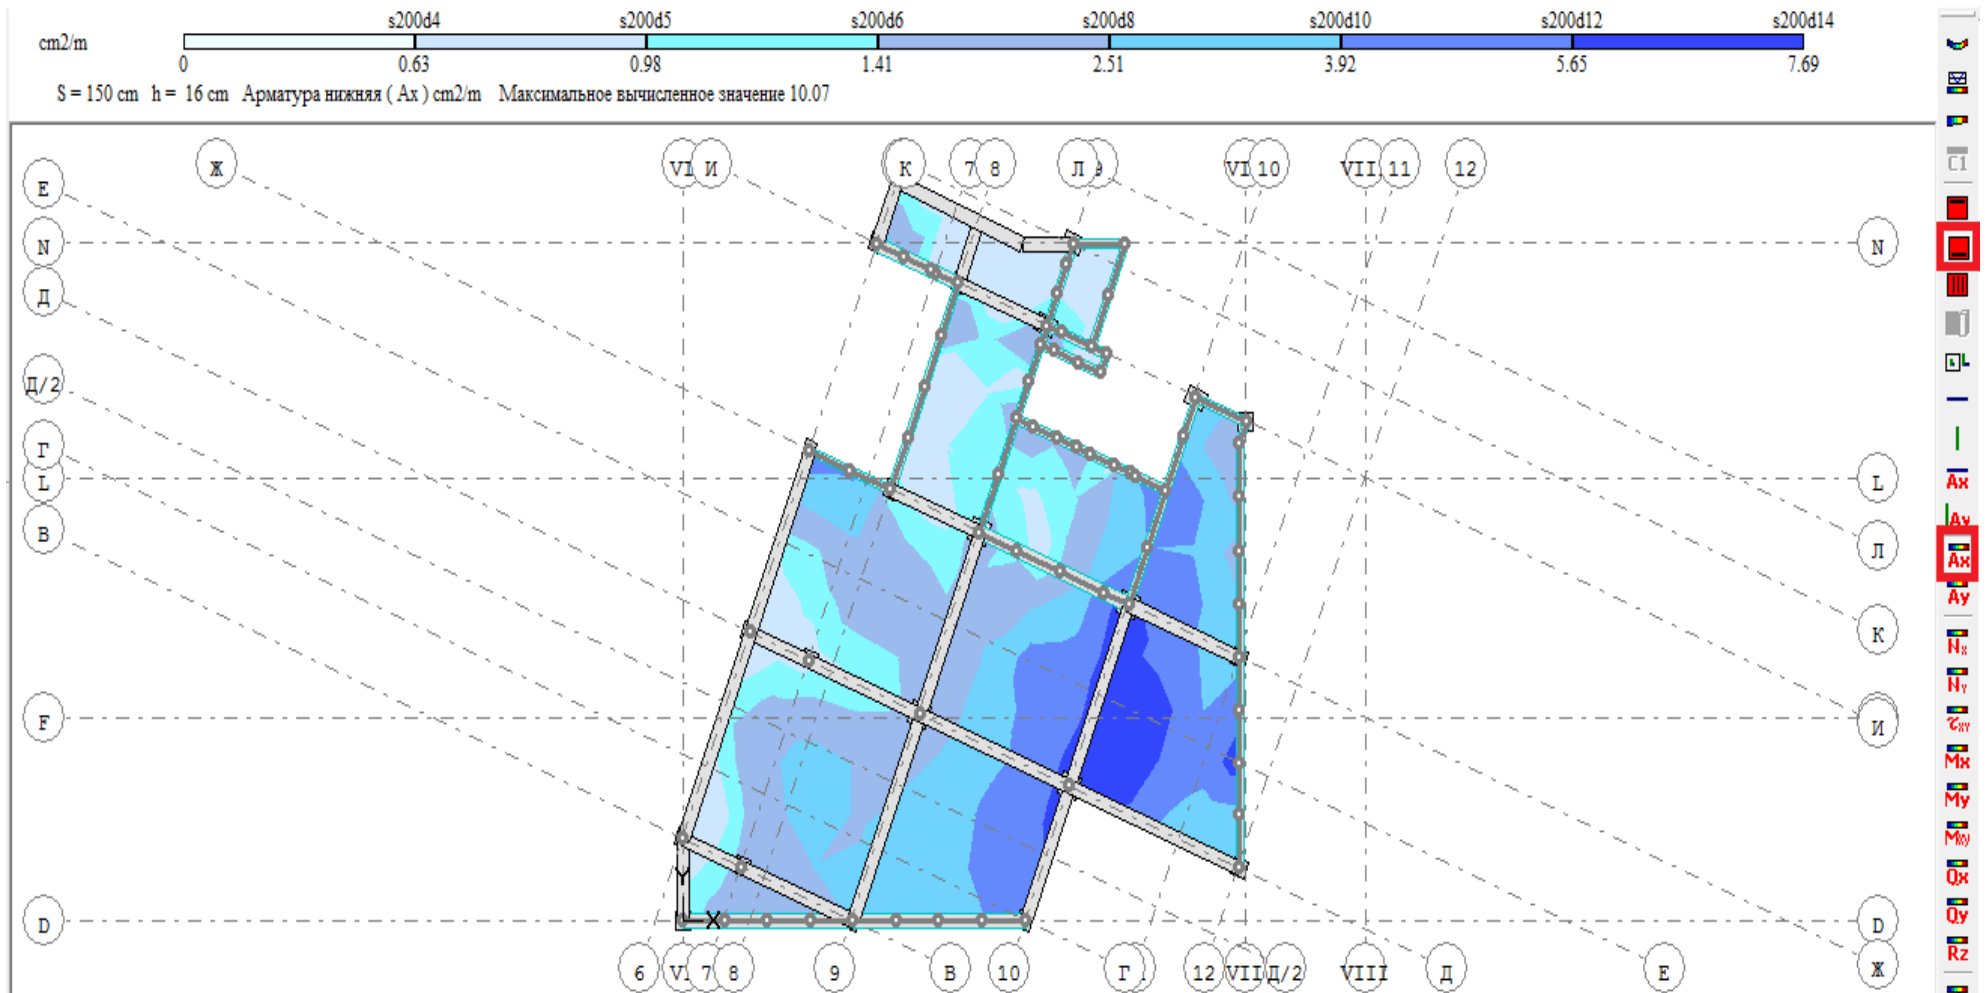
Плита перекрытия на першому поверсі. Розподіл робочої арматури по нижній грані плити у напрямку вісі ОХ
